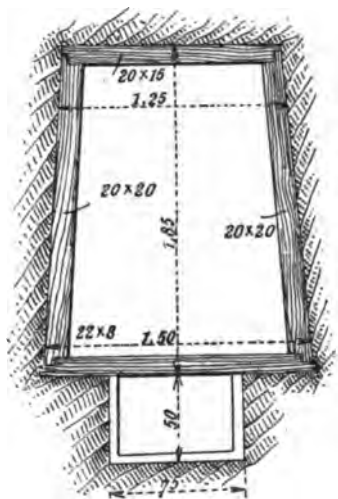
Galerie de conduite des eaux (coupe transversale).
